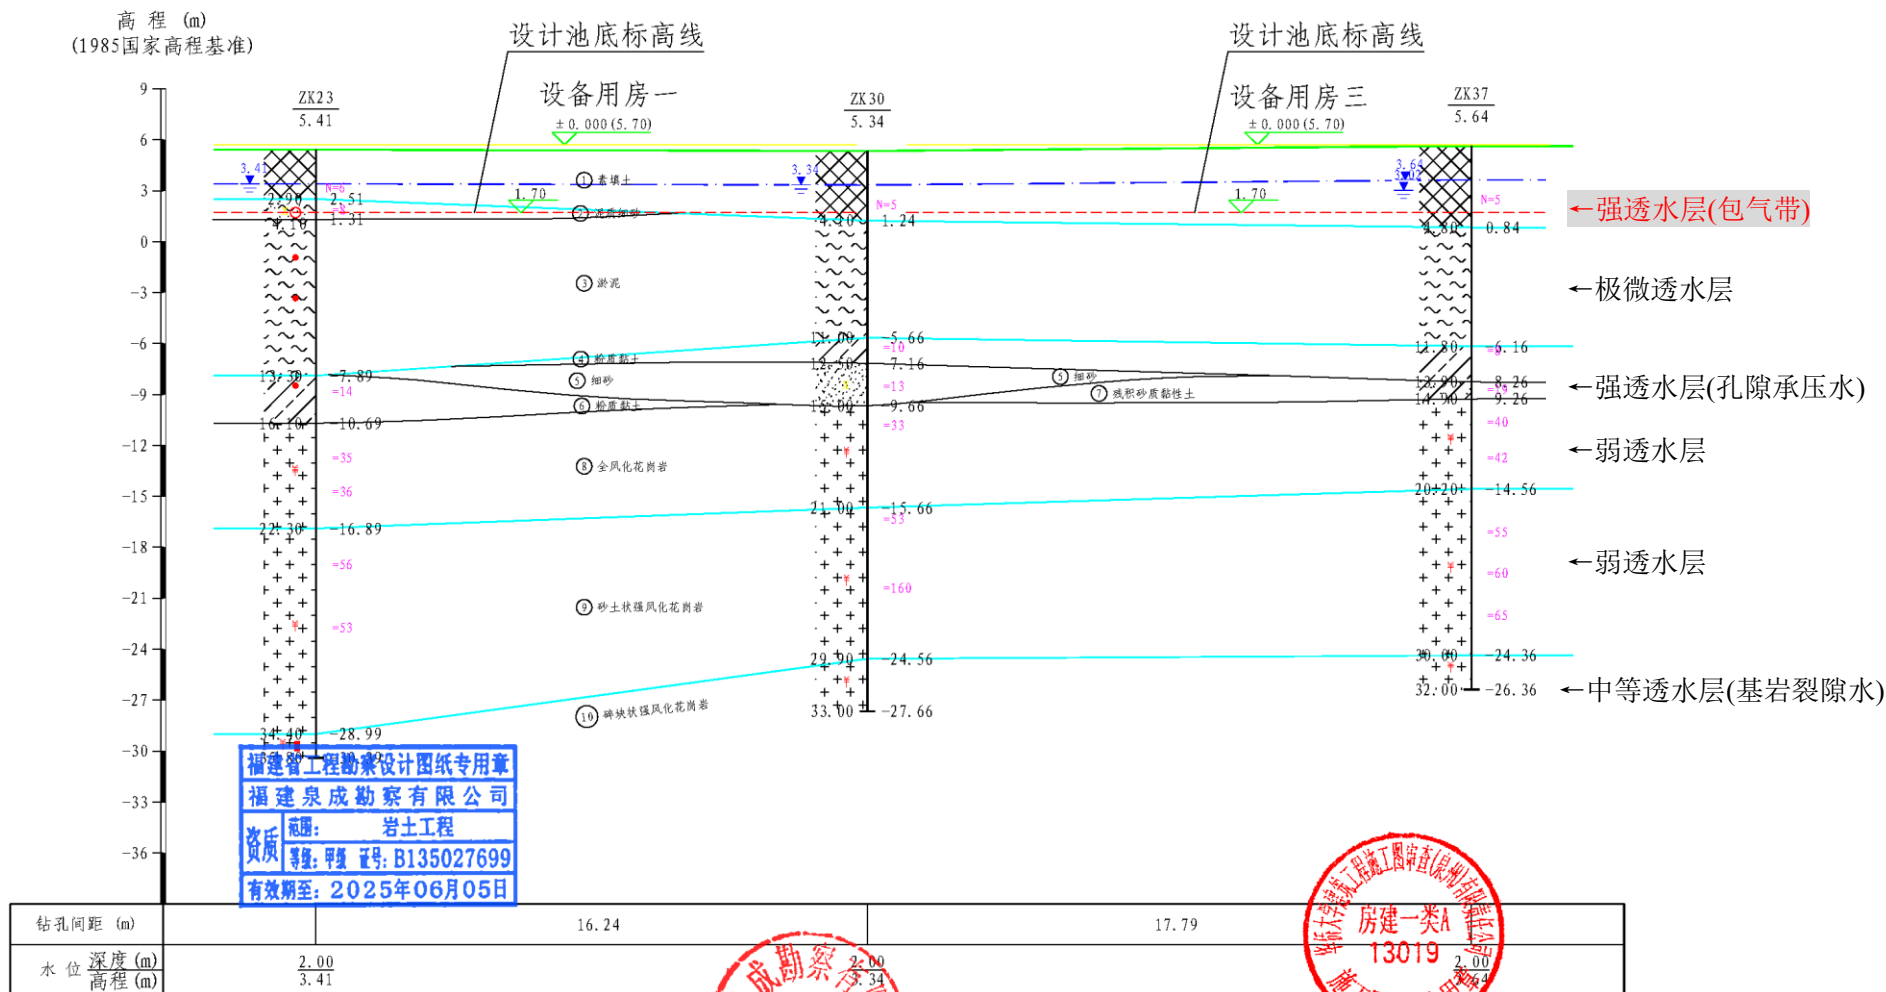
污水处理设施调节池区域地质剖面图 (摘录)
